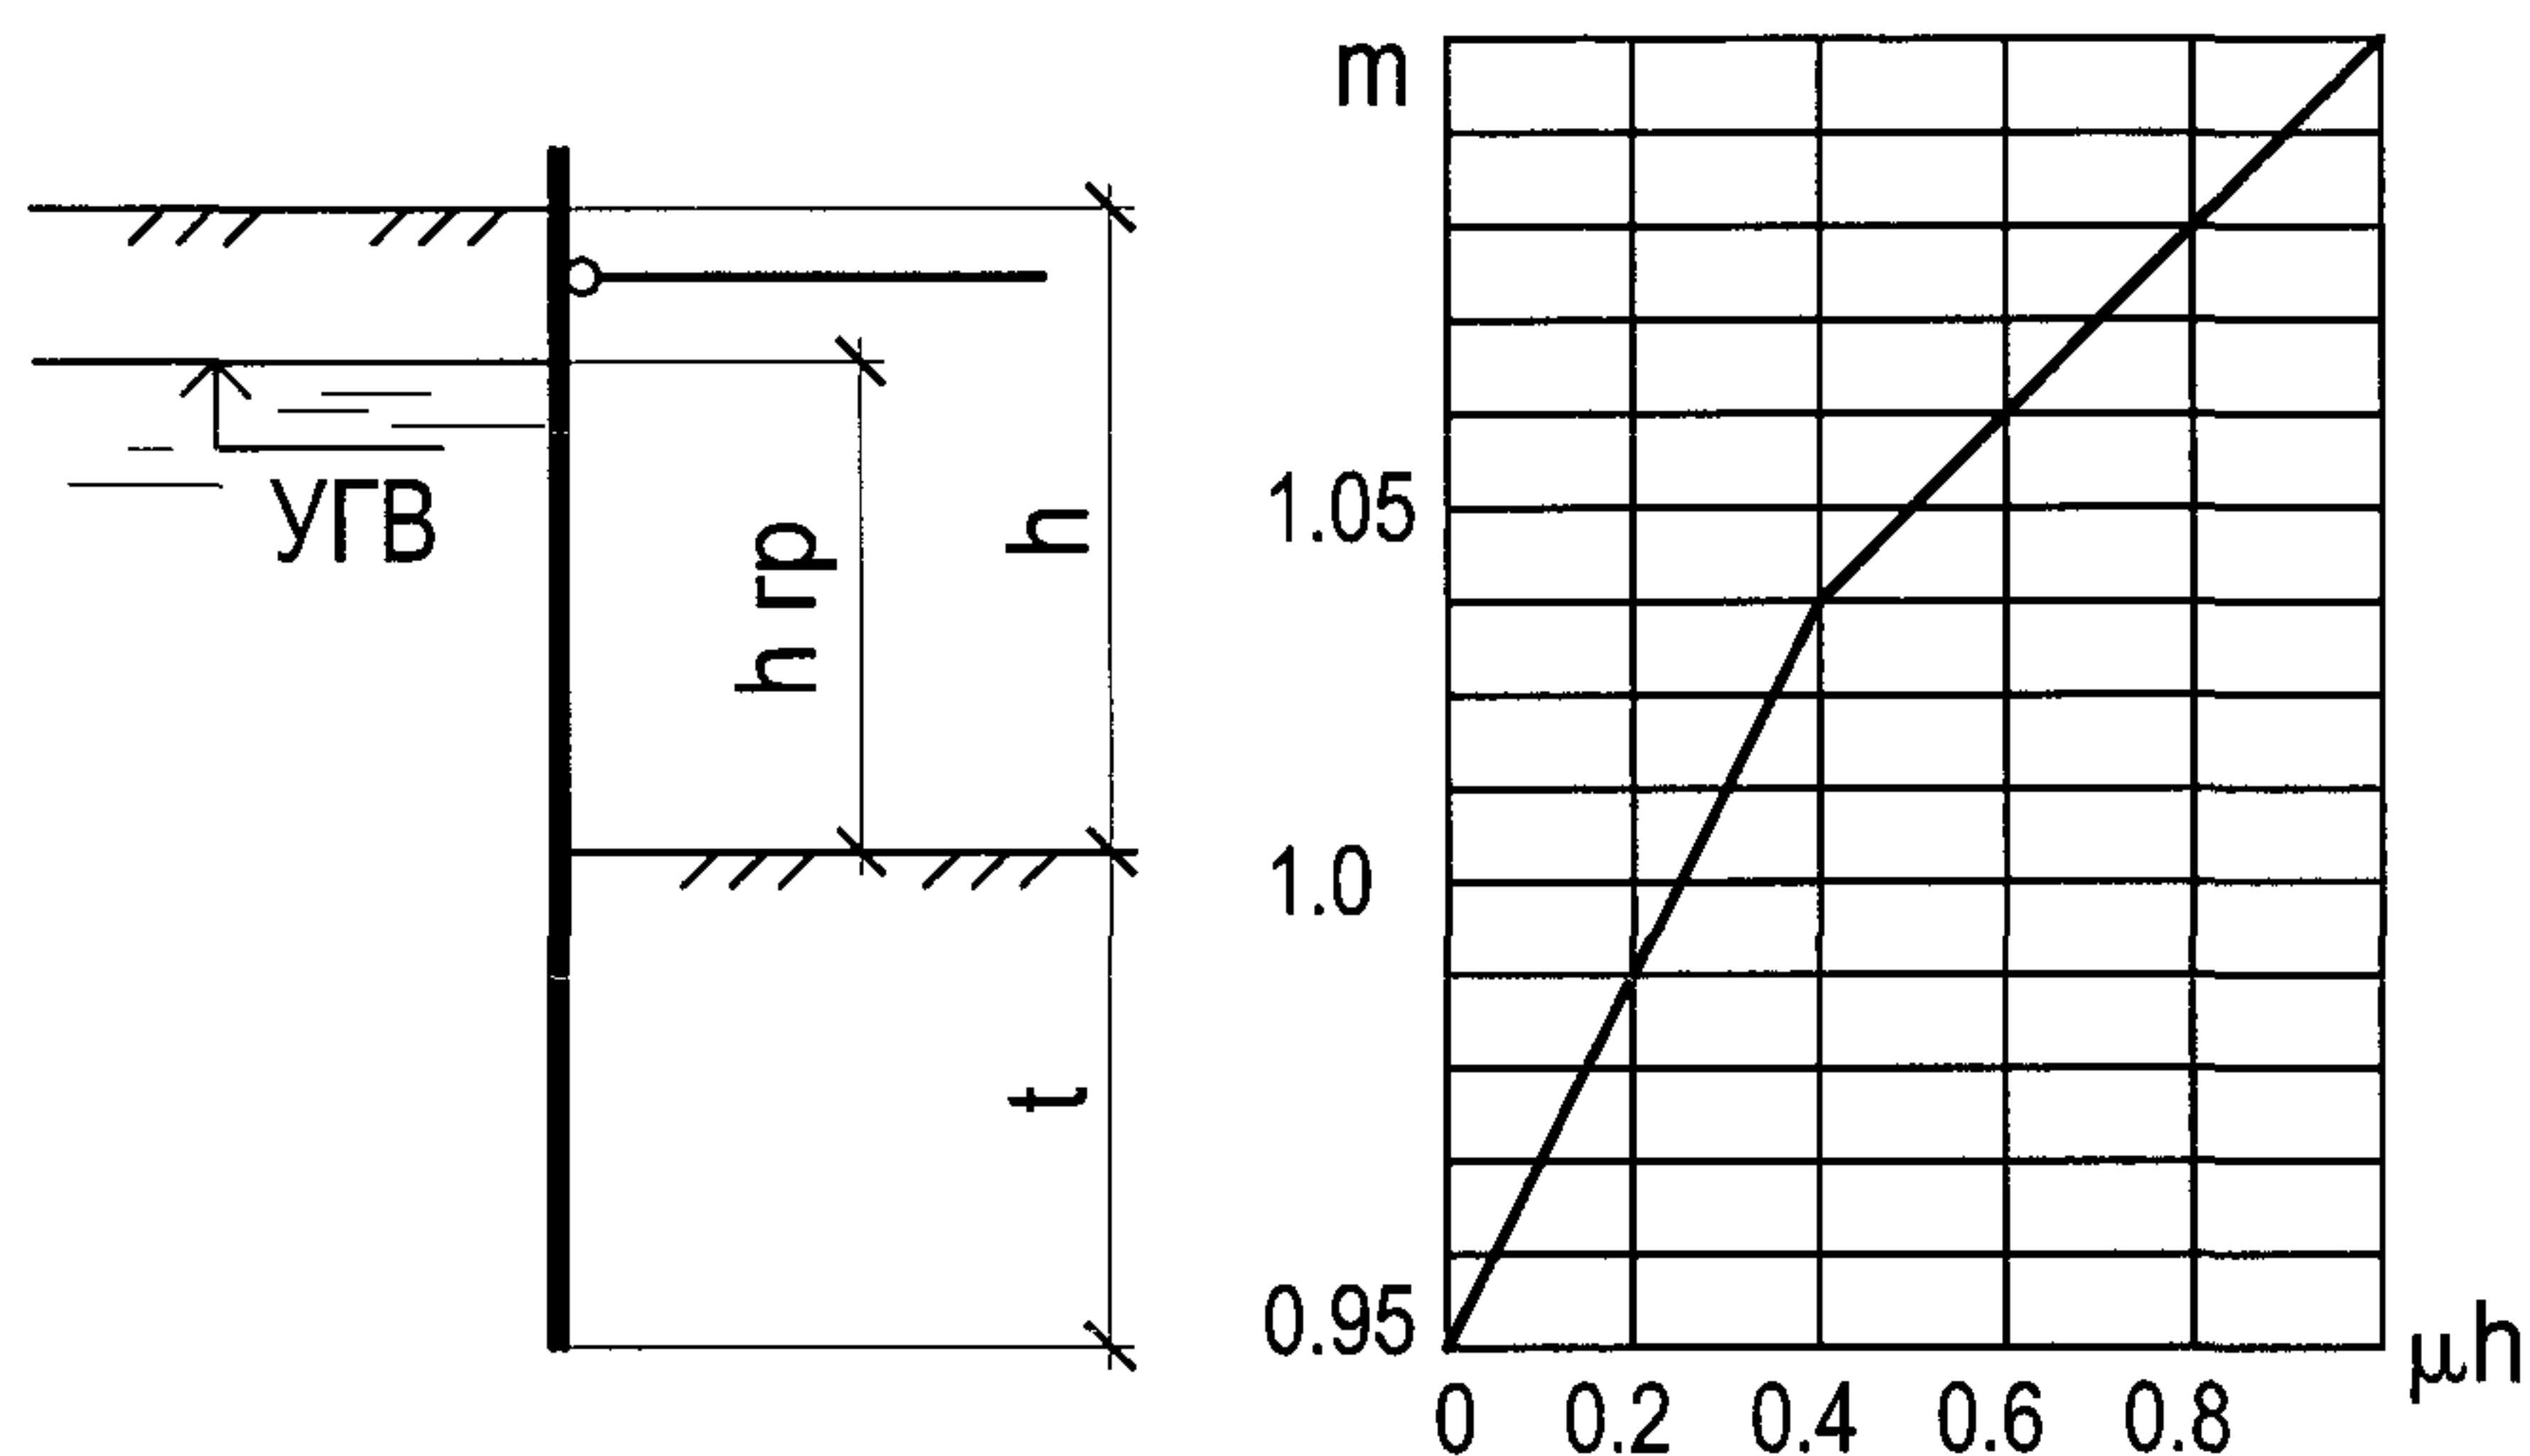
Схема и график для определения коэффициента условий работы в расчете устойчивости шпунтового ограждения на местности, не покрытой водой
